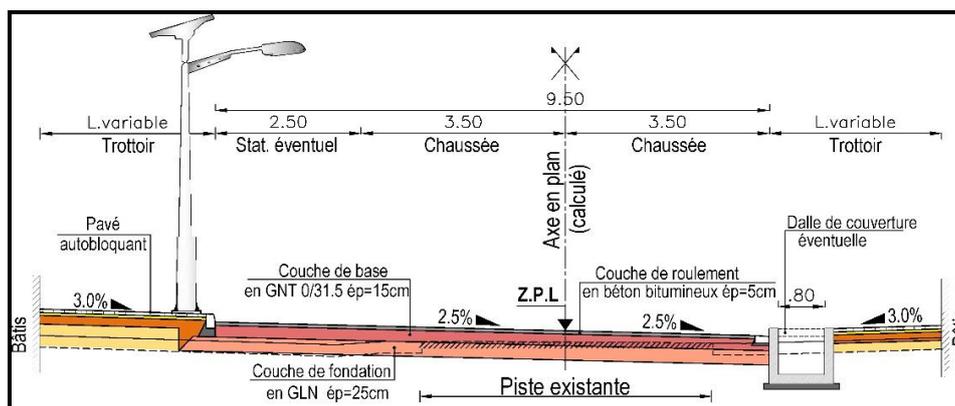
Profil en travers type des voies d'accès des sites touristiques de Ouidah à emprise réduite
